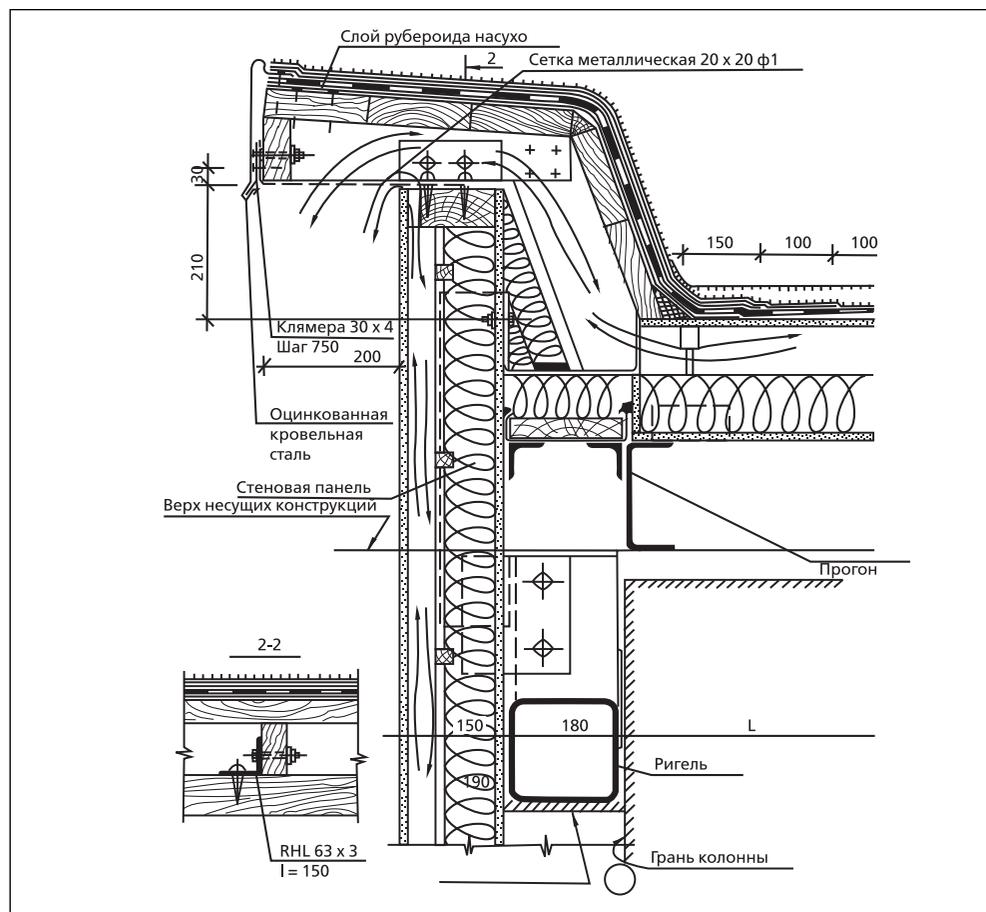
Конструкция парапета с использованием древесины для вентилируемых крыш и стен из каркасных плит
